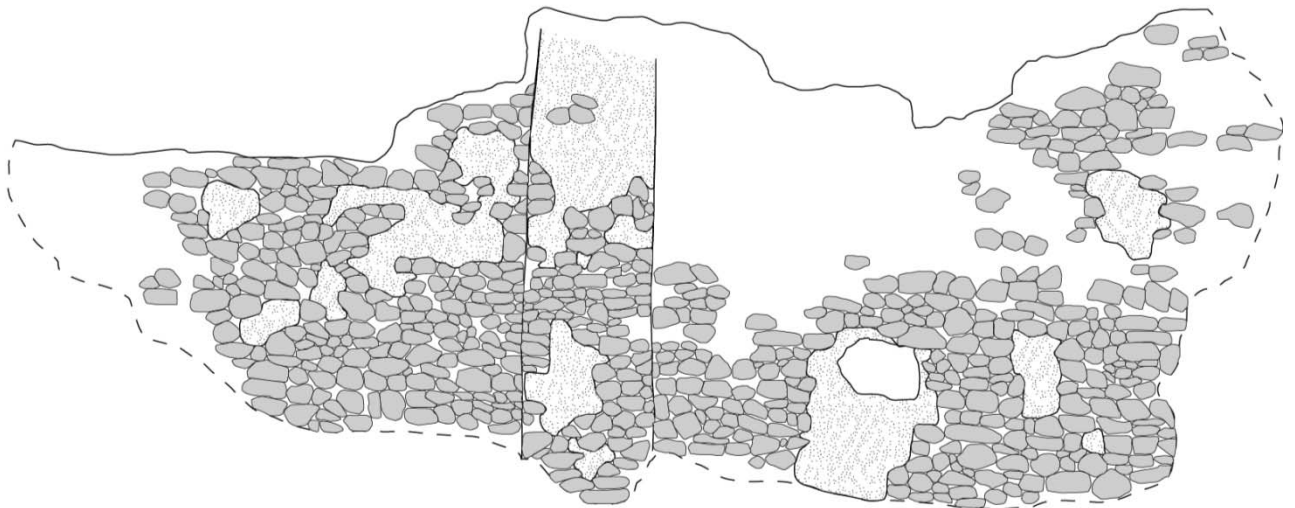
SECTEUR 2 - RELEVÉ RESTITUÉ DU PAREMENT (D'APRÈS PHOTOGRAMMÉTRIE)
